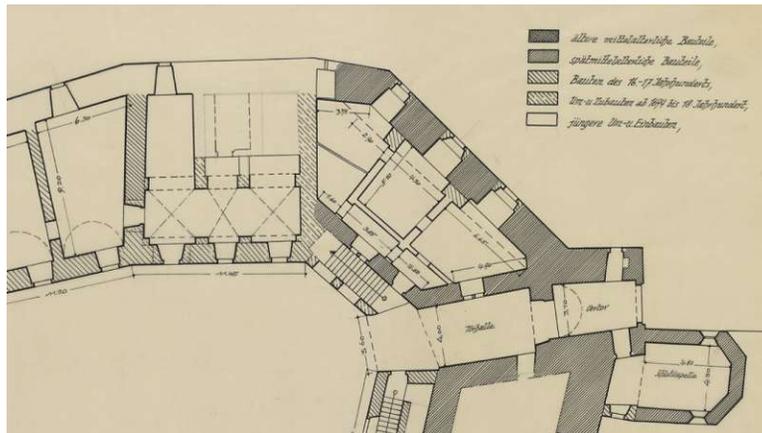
Grundriss mit Bauphasen (1955)
